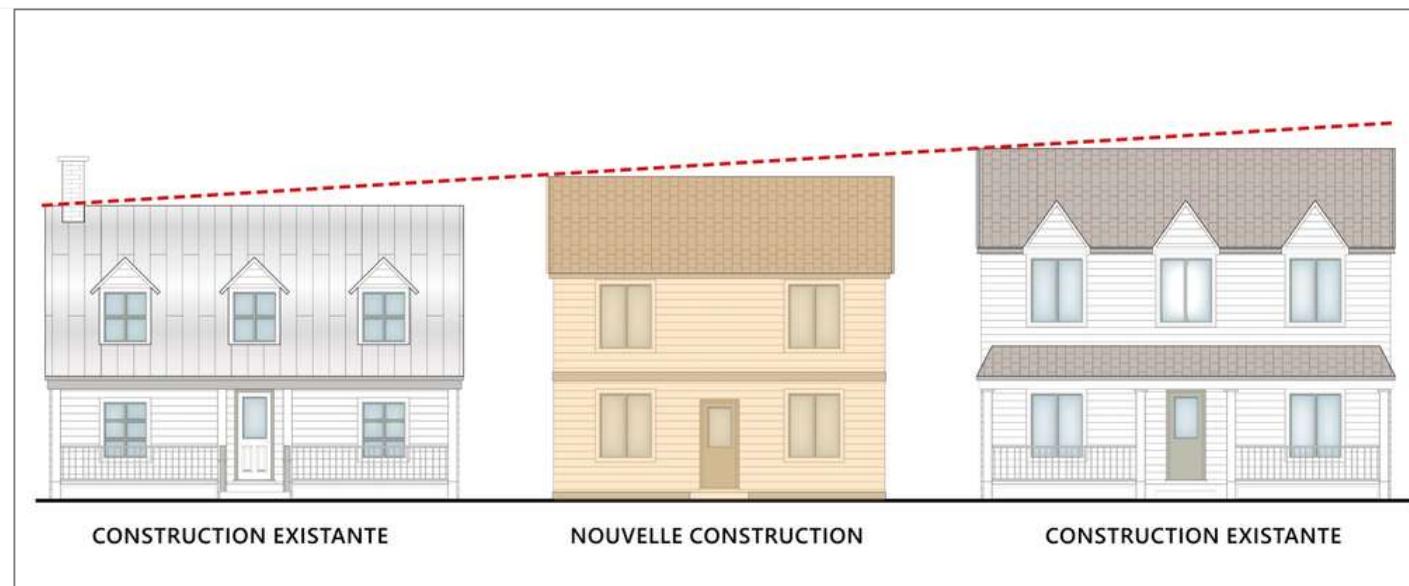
La différence de hauteur entre deux bâtiments adjacents, mais non contigus ne doit être de plus d'un demi-étage.
